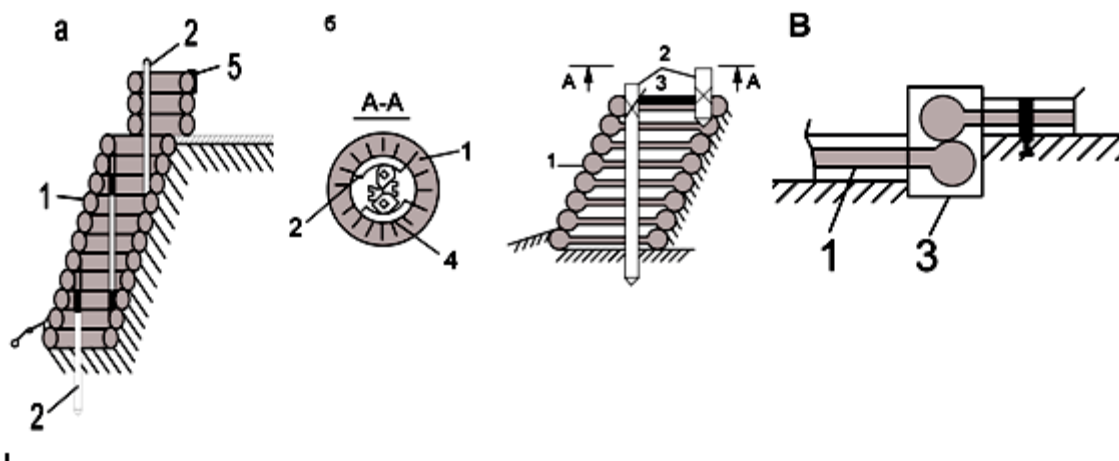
Конструкция подпорной стенки из изношенных автомобильных шин: а - укрепление нижнего и верхнего откосов автомобильными покрышками; б - поперечное сечение покрытия - схема соединения стоек с покрышками; в - соединение покрышек хомутами. 1- автомобильная покрышка; 2 - анкерные сваи; 3-хомут; 4 - булыжники; 5 - ограждение террасы, согласно [11]
